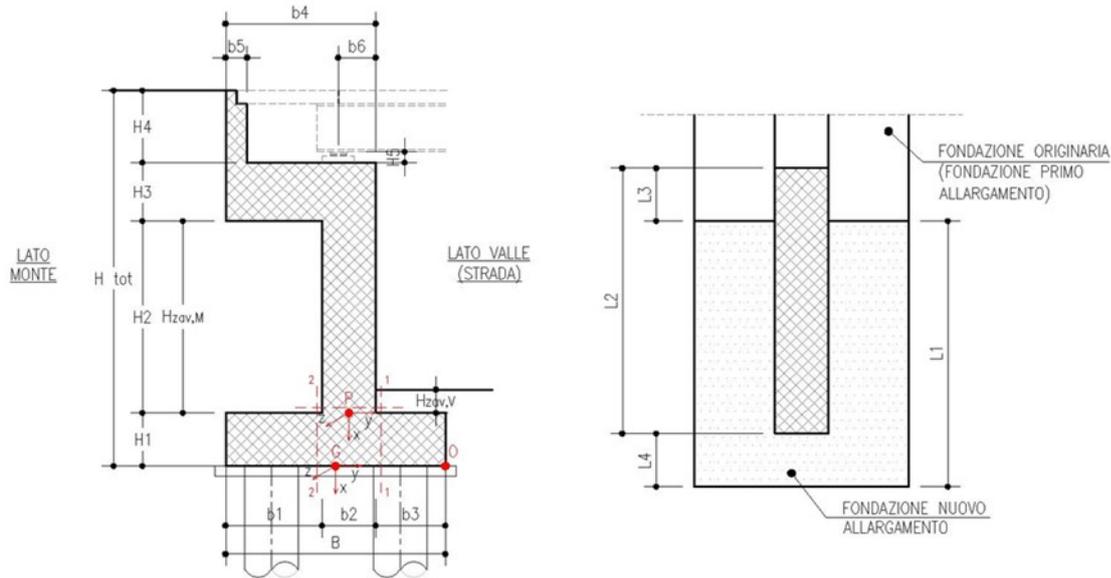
Documento as-built “Sottovia Interconnessione 6 dell’autostrada A14 al km 14+490” – Sezione trasversale con armature paraghiaia.
